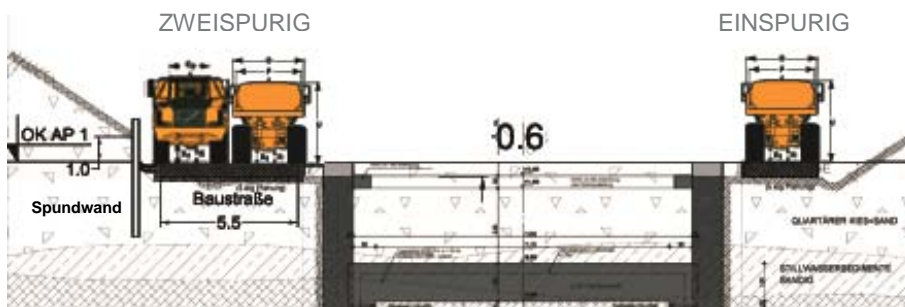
Gegenüberstellung einer ein- und zweispurigen Baustraße
